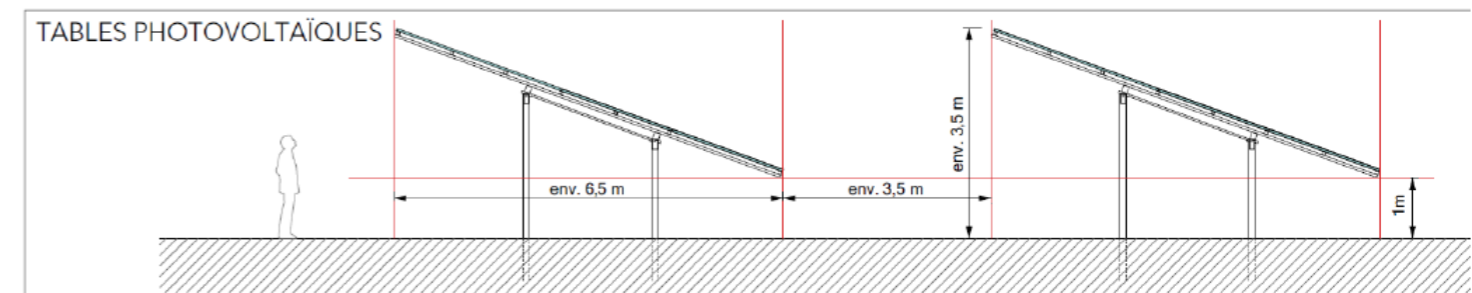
Vue en coupe d'une table photovoltaïque en pieux (Source : Photosol)
